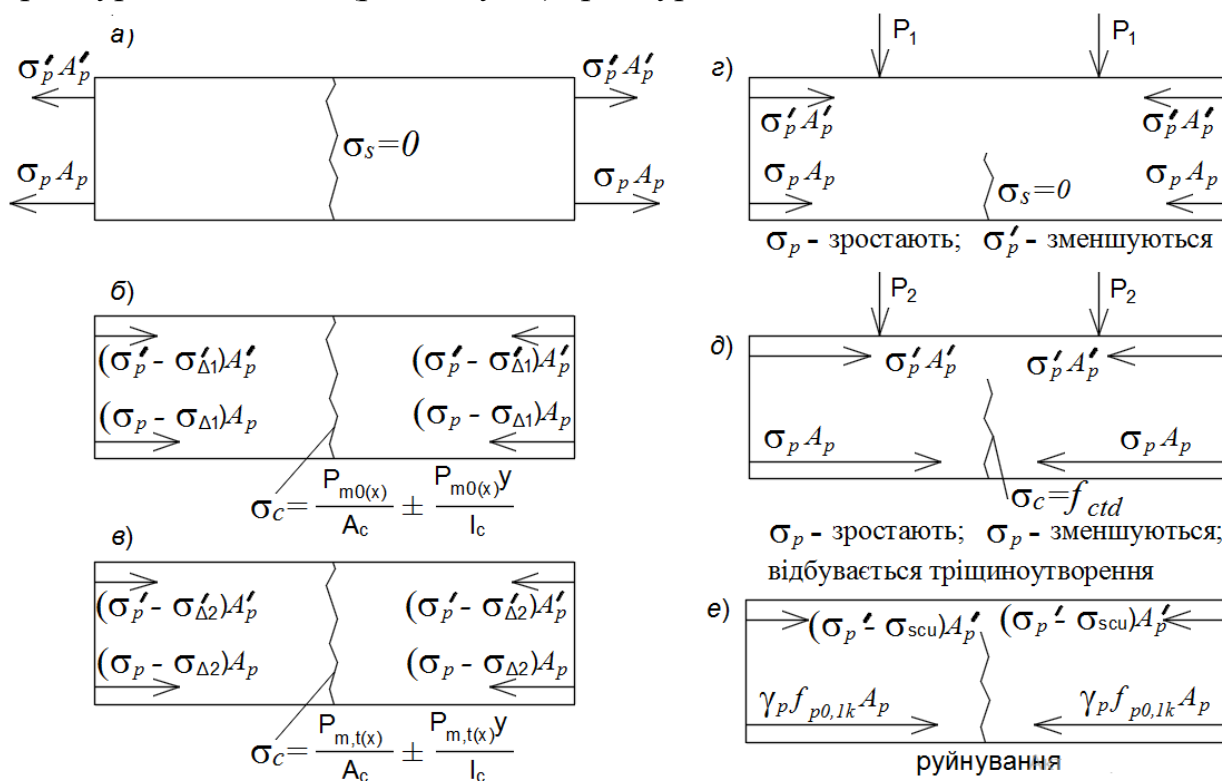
Послідовність стадій напруженого стану поперечно напруженого залізобетонного елемента: а – перша стадія – натягування арматури «на упори» у верхній частині елемента та нижній; б – передача напружень на бетон після звільнення арматури від упорів та врахування миттєвих втрат; в – подальше обтиснення бетону з урахуванням втрат, залежних від часу; г – прикладання зовнішнього зусилля  $P_1$  та погашення напружень обтиску бетону в розтягнутій зоні до рівня  $\sigma_c = 0$ ; д – збільшення зовнішнього зусилля до  $P_2$ , до рівня тріщиноутворення, збільшення напружень в розтягнутій арматурі та зменшення напружень в умовно стиснутій арматурі; е – збільшення зовнішнього зусилля до  $P_3$  та руйнування залізобетонного елемента, розрахунковий опір арматури  $\sigma_p = \gamma_p f_{p0,1k}$
